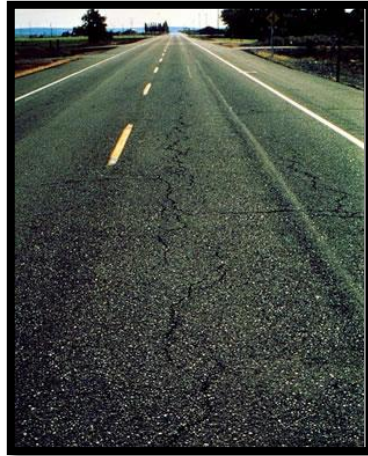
Grietas longitudinales y transversales severidad baja
